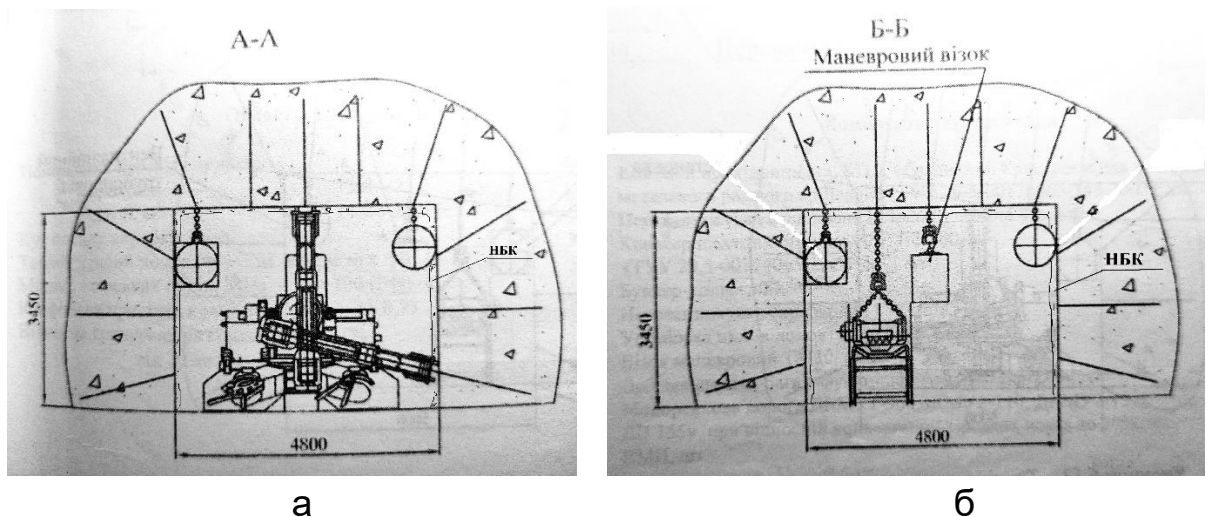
Перетини виробки прямокутної форми з анкерно-набризкбетонним кріпленням
